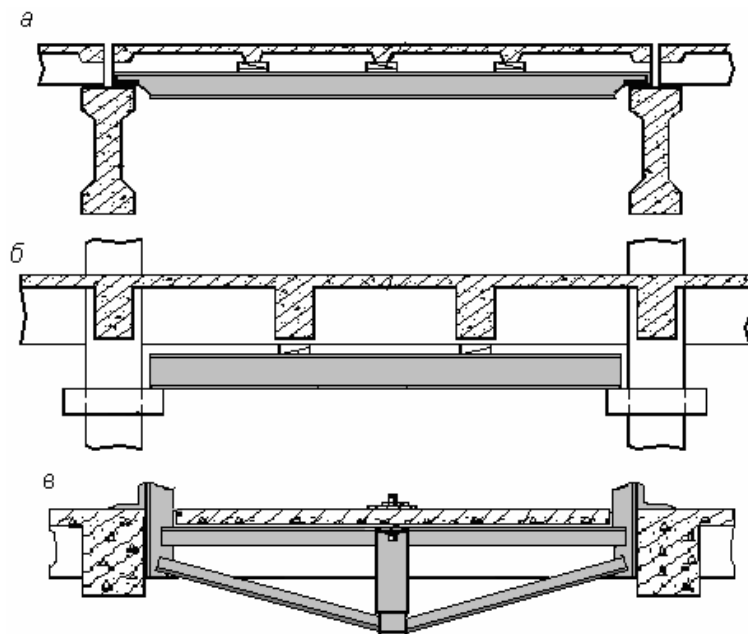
Усиление конструкций дополнительными упругими опорами в виде:
